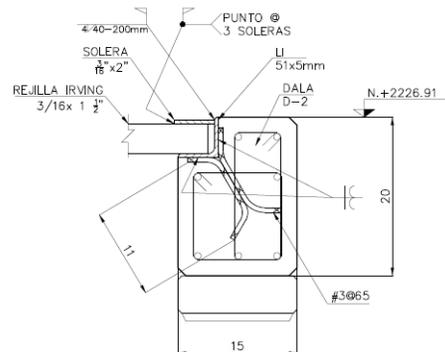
Detalle de fijación de Rejilla Irving en dalas superiores tipo D-2.
